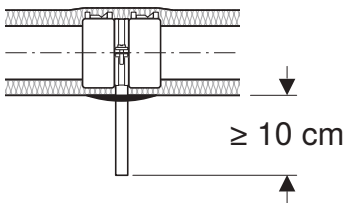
Fixpunkt för betongingjutna, isolerade Geberit utloppsrör
